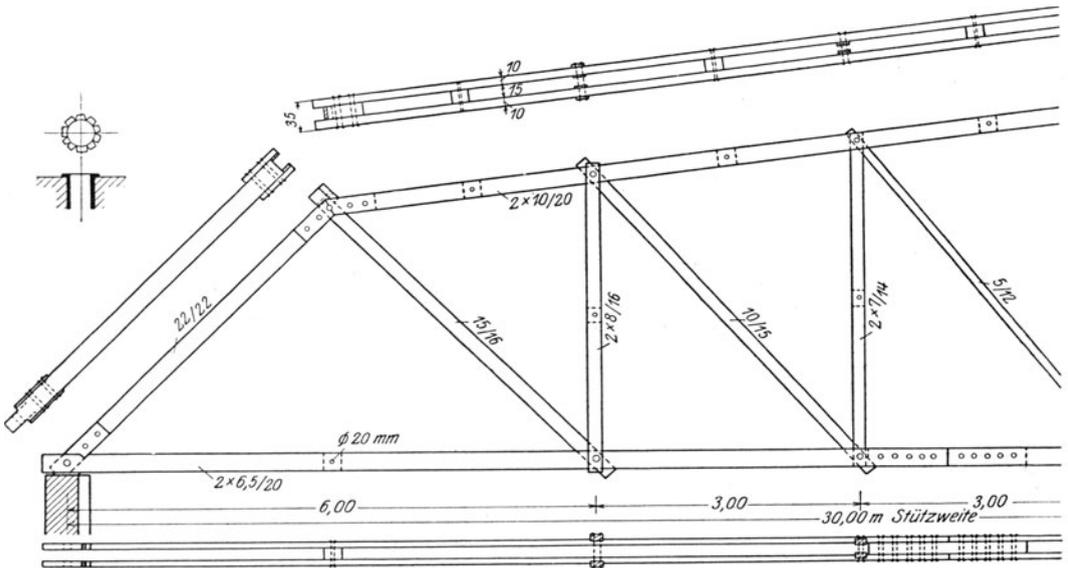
Fachwerkträger mit gewöhnlichen Rohrdübelverbindungen.
